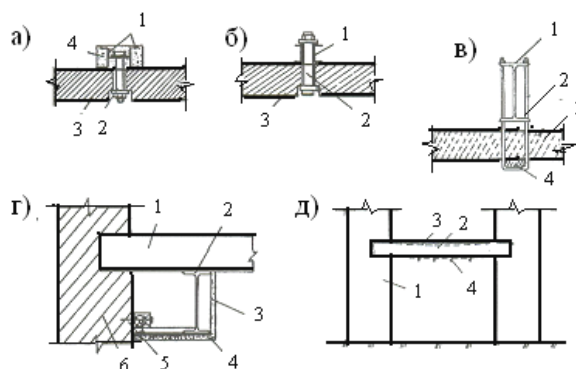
Схемы устранения прогибов перекрытий полносборных зданий:
